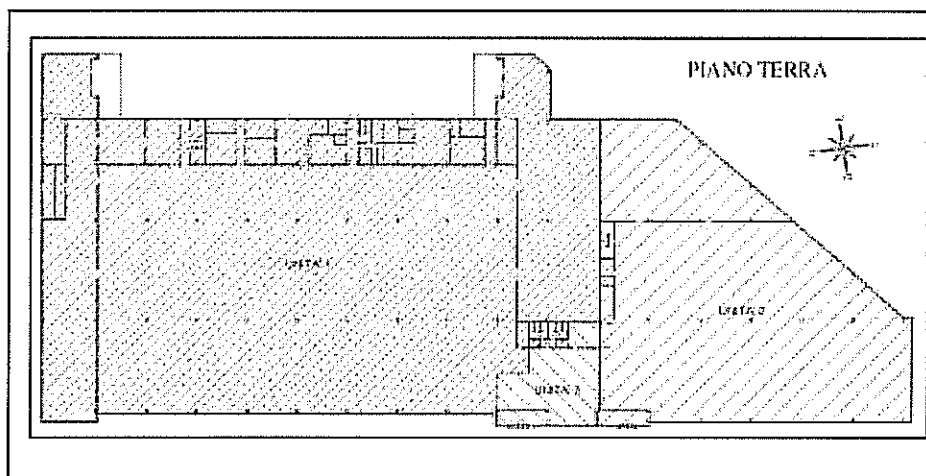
Progetto dell'intervento con suddivisione in tre unità
